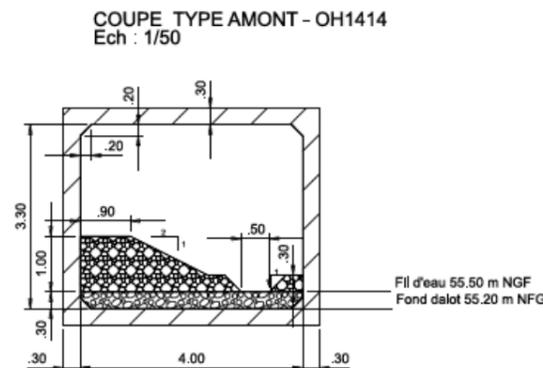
Coupe type de la banquette prévue sur l'Ingon (OH1414)
